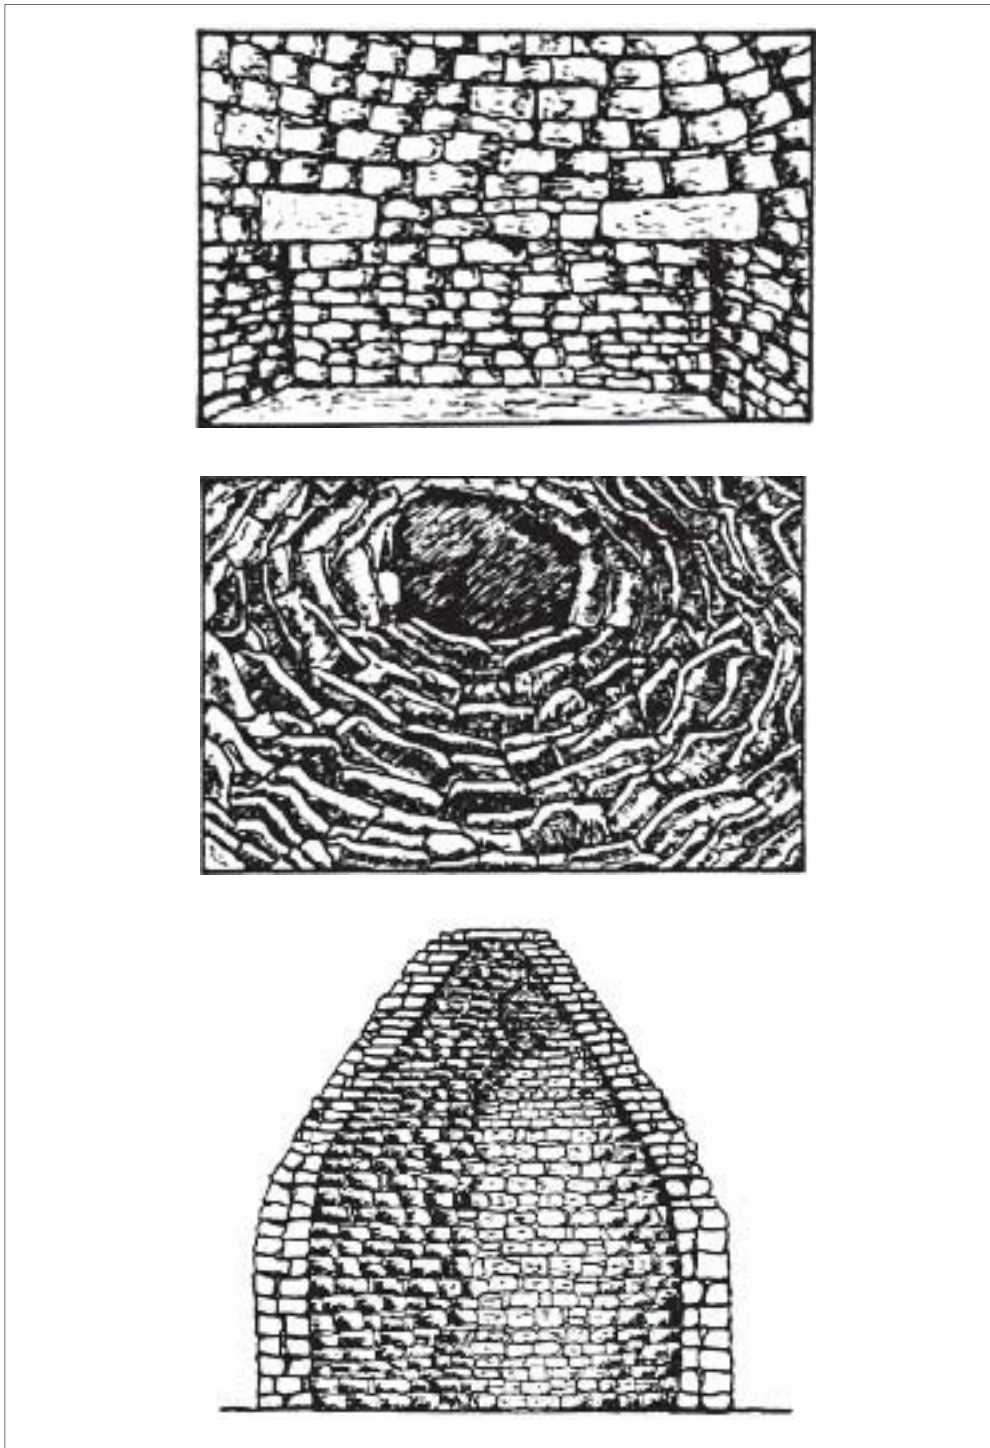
Choza de planta cuadrada y falsa cúpula y sección de choza de planta circular.
